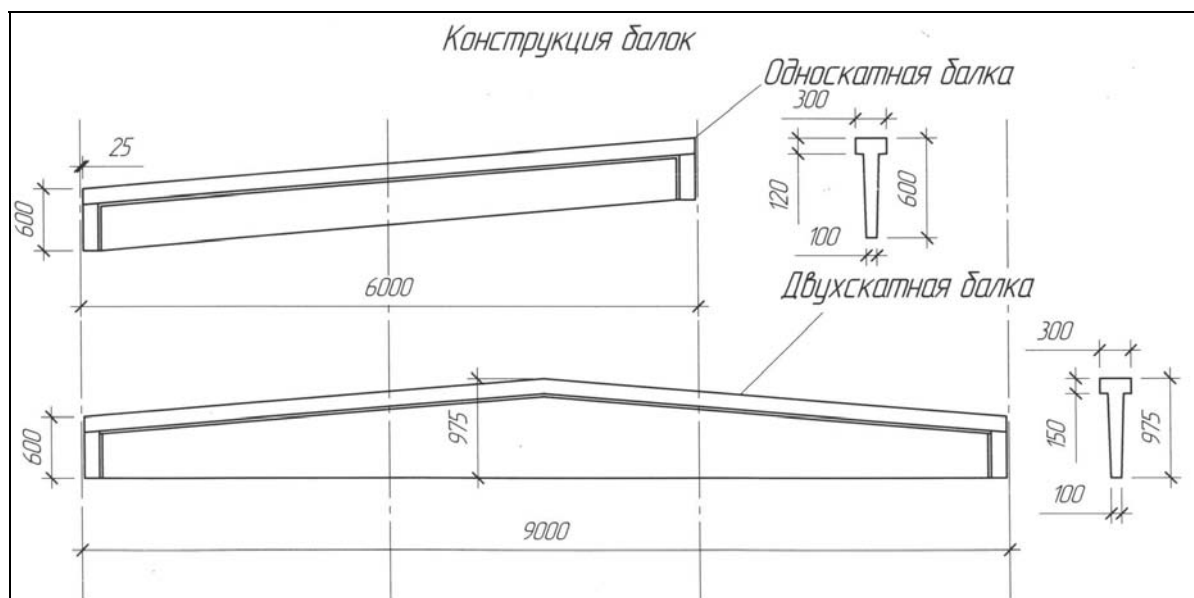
Конструкция балок скатных покрытий пролетом 6 и 9 м
